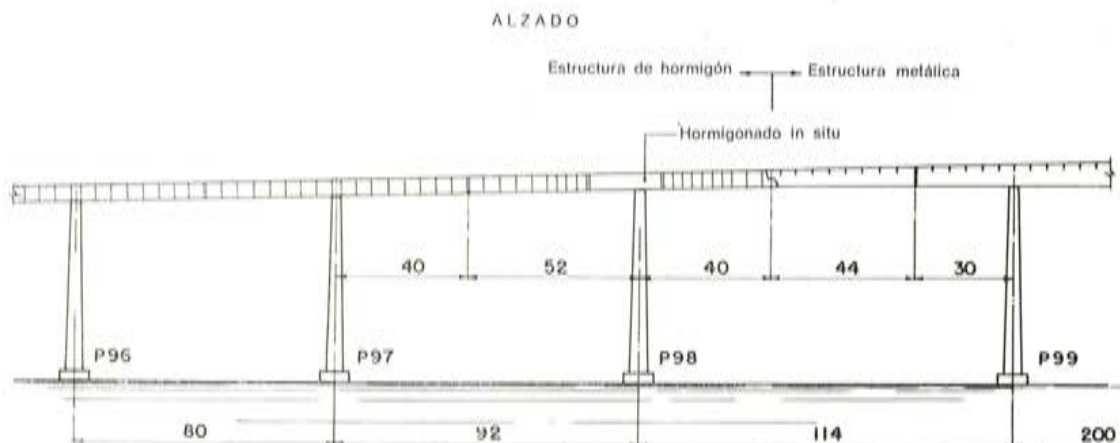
Tramos de hormigón adyacentes a la estructura metálica.
